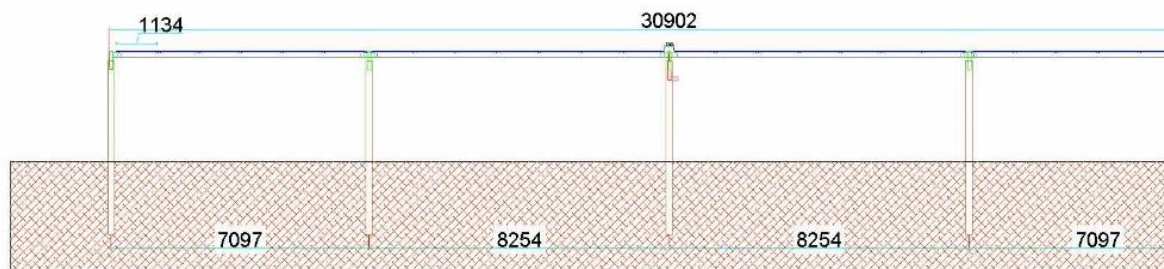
Tipologico struttura sostegno moduli – prospetto
